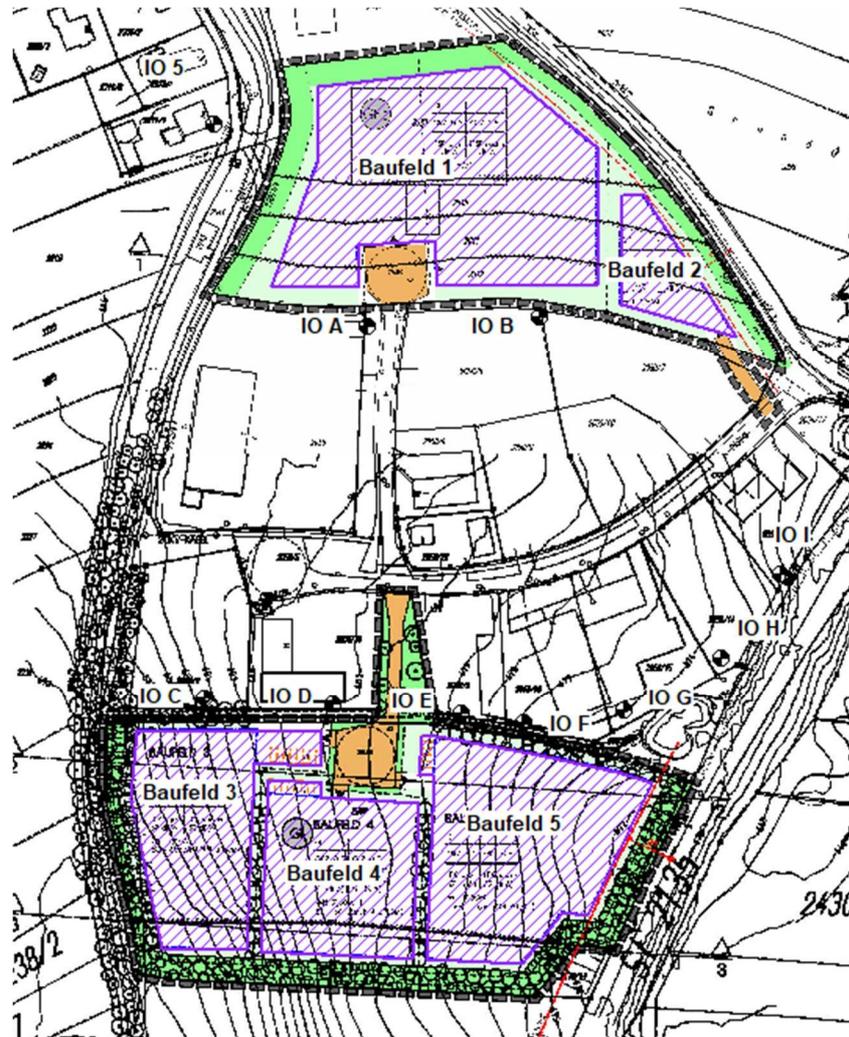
Emissionsbezugsflächen der Baufelder 1 - 5 des ursprünglichen Bebauungsplanes GE/GI "Scheibe Erweiterung"
